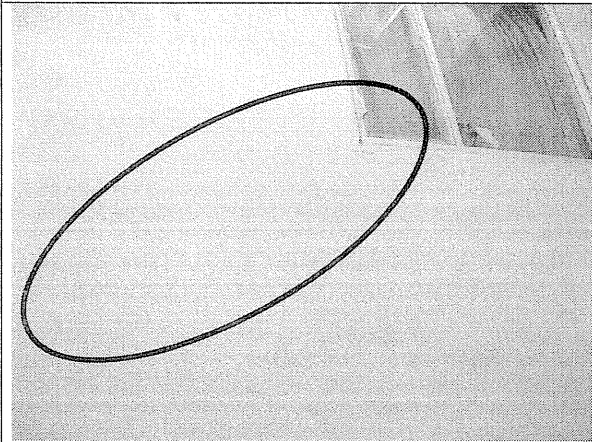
Fisura en muro a partir de la esquina de la ventana.
